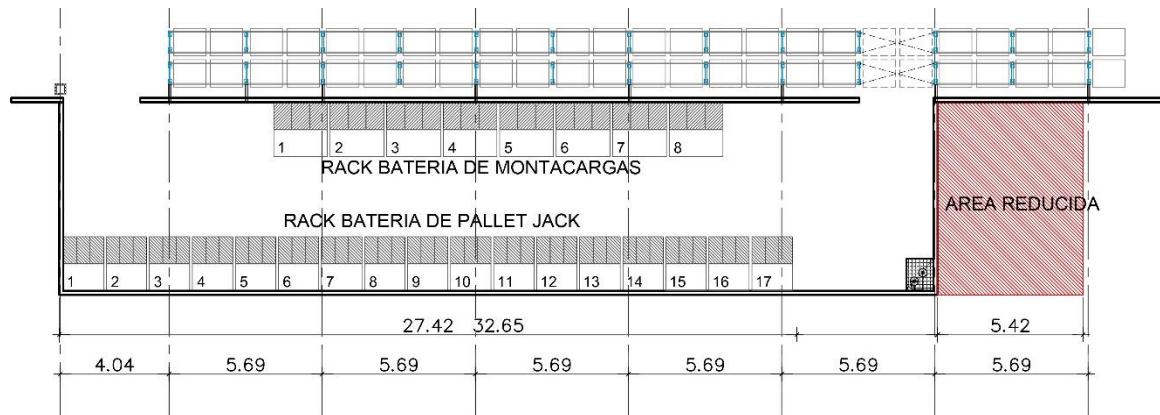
PLANO DE APOYO, MONTACARGAS ACOTADO EN CANÓPIA OESTE.
